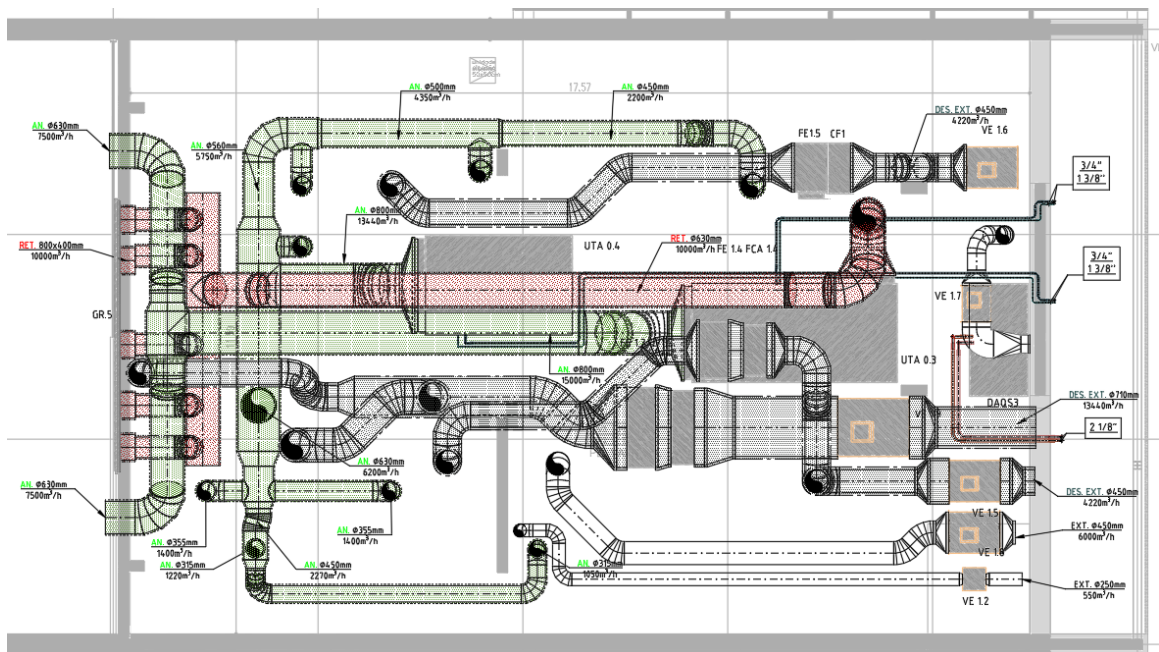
Preparação da área técnica interior do piso 1 do restaurante
